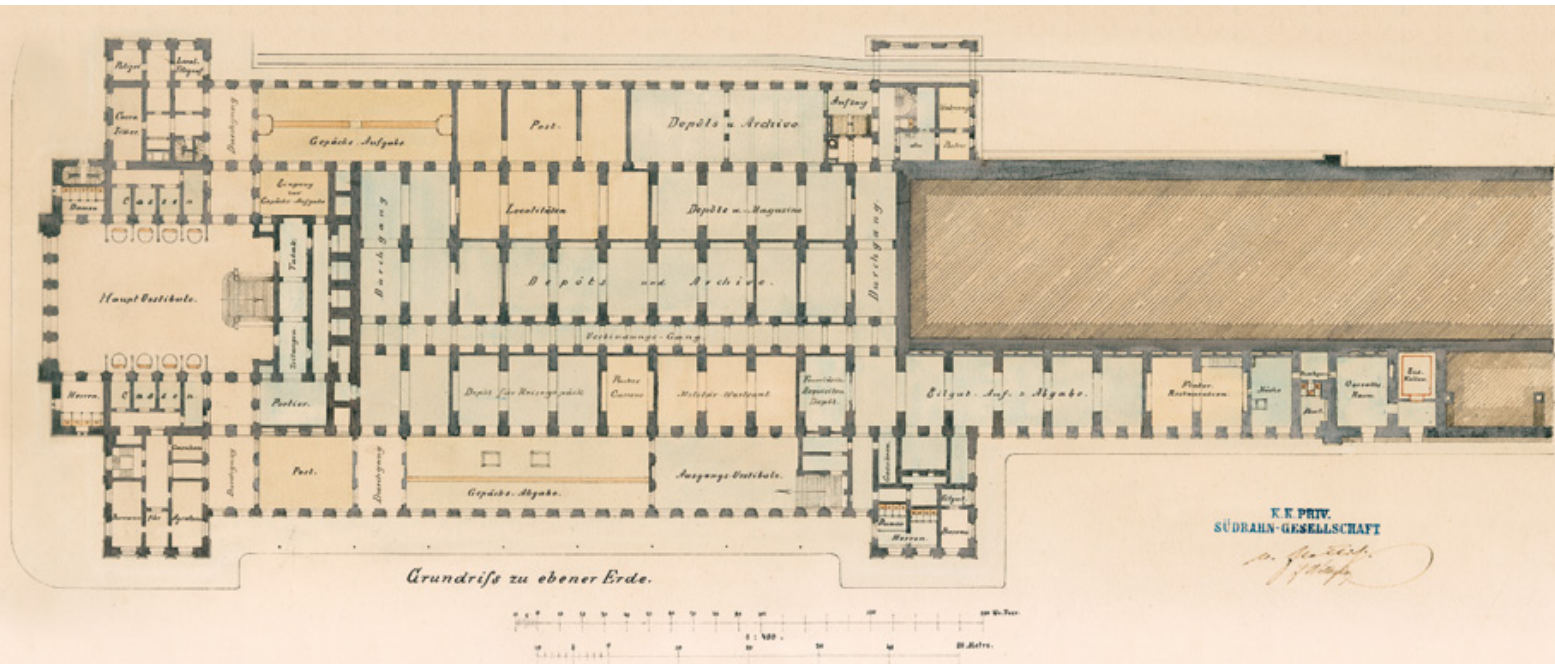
Südbahnhof, Grundriss zu ebener Erde, 1869. Wilhelm Flattich. Franz Wilhelm, Tuschefederzeichnung aquarelliert.
